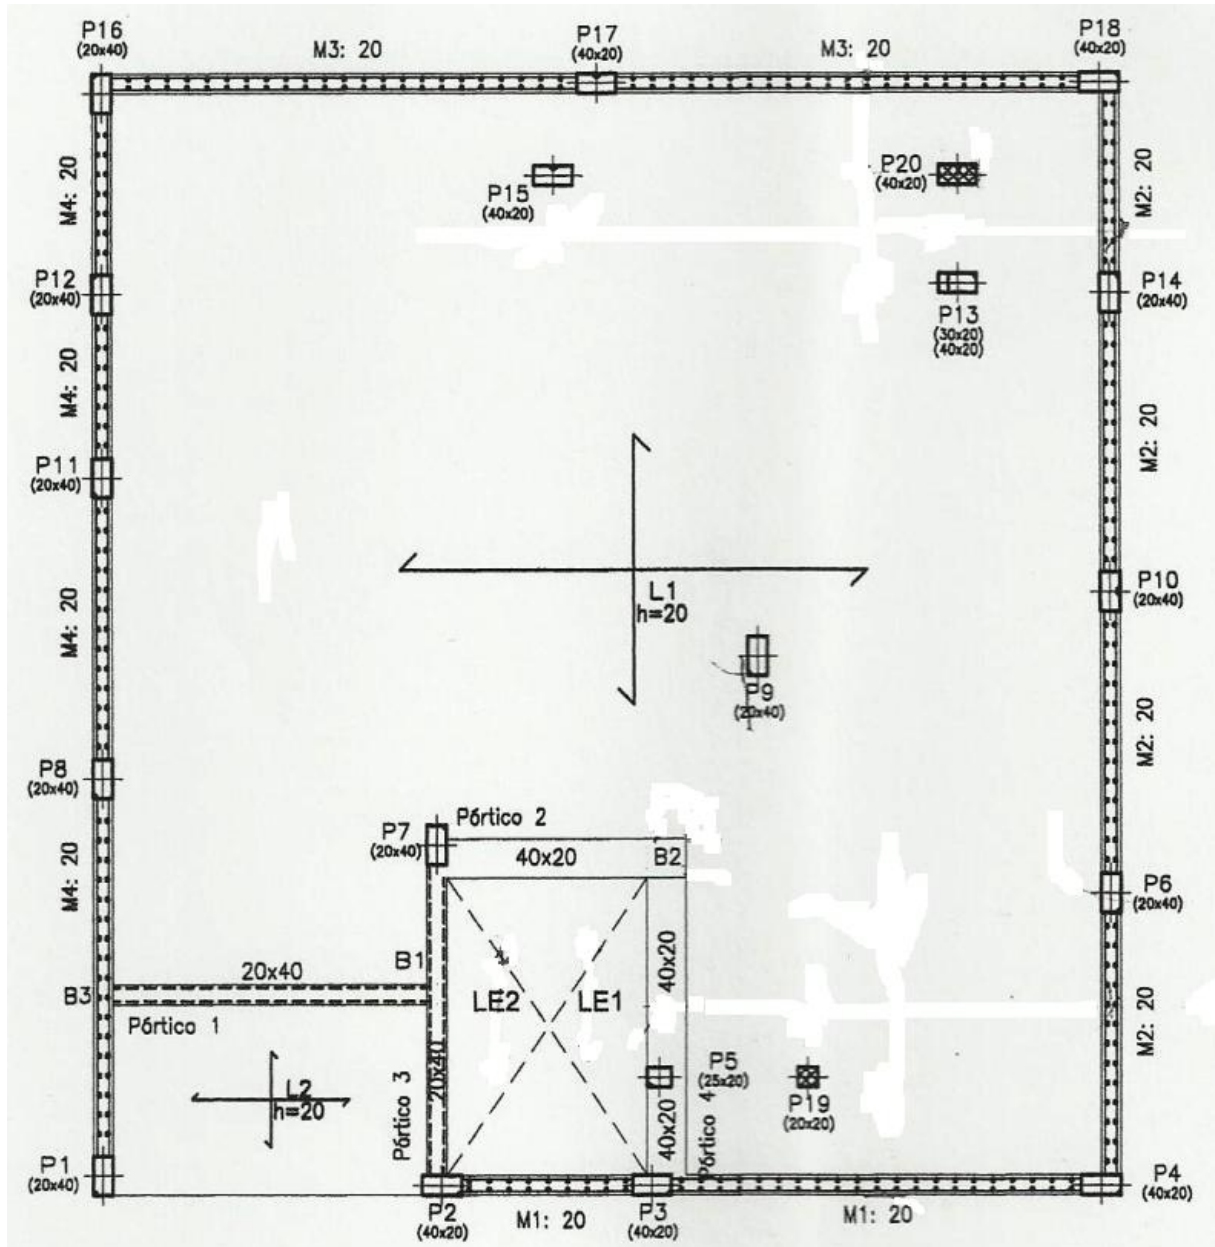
Projeto de Estabilidade – Planta do Teto da Cave
